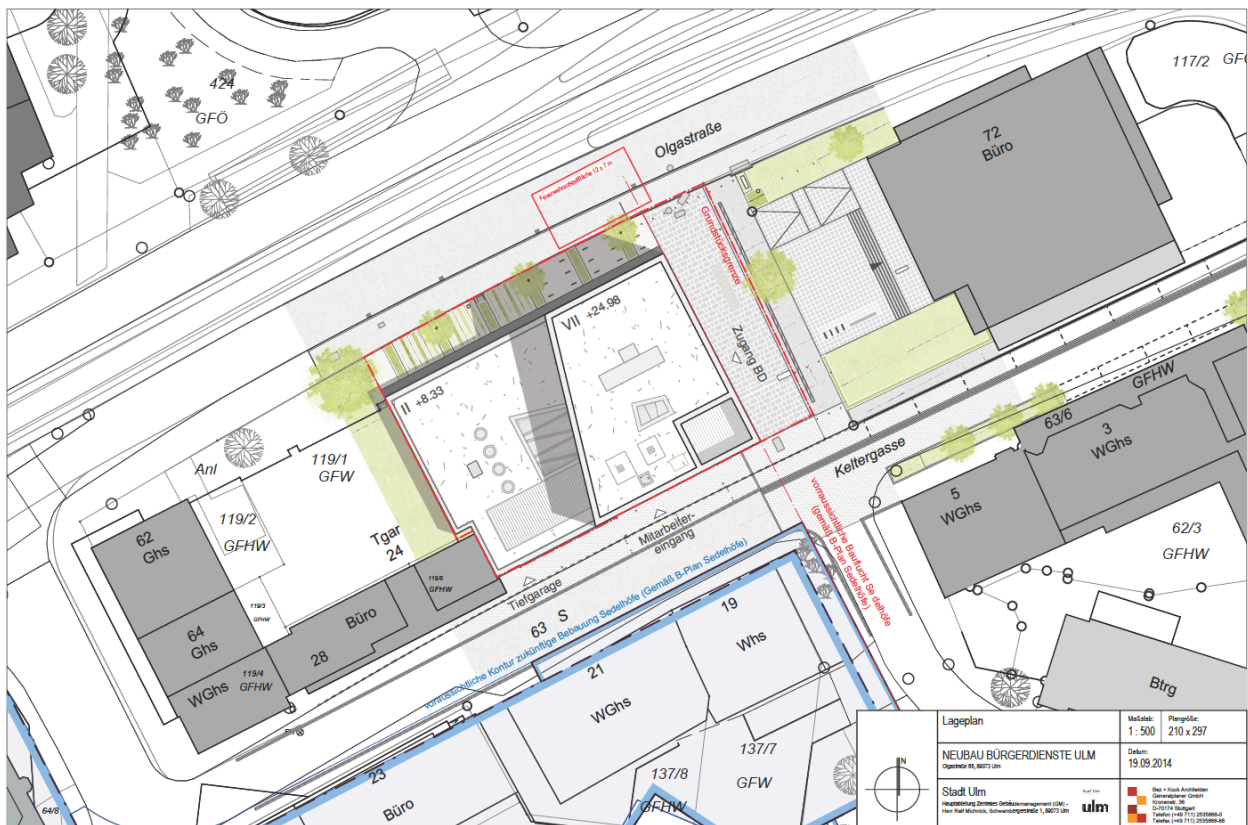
Lageplan Neubau Bürgerdienste<sup>15</sup>
